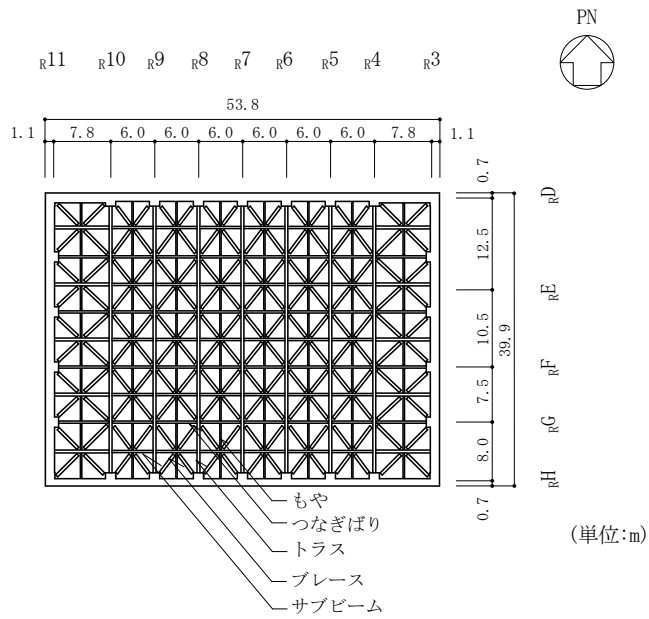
(9) 原子炉建物の概略平面図 (EL 63.5m)
